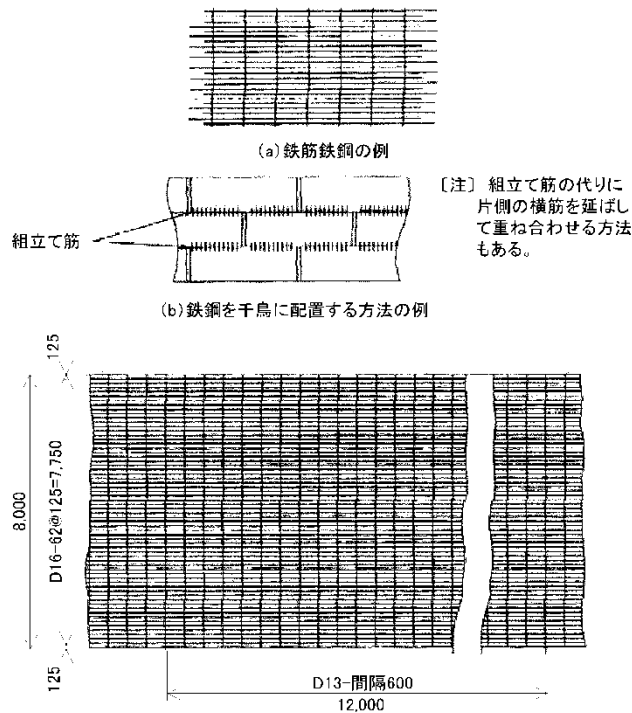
連続鉄筋コンクリート版の配筋(単位: mm) (参考)
